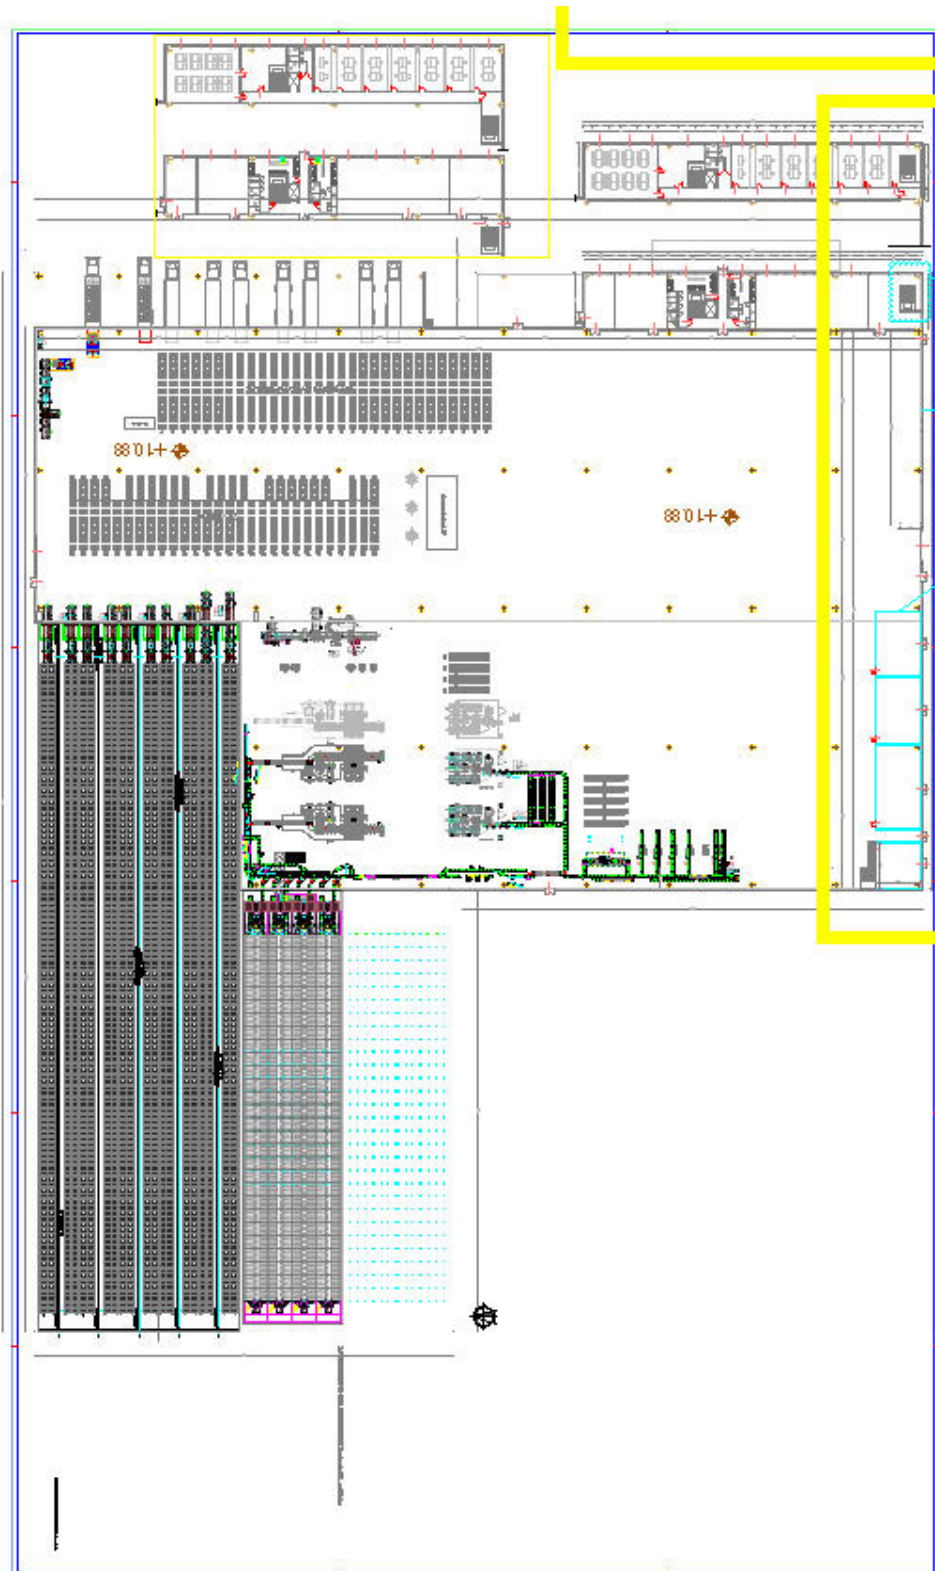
elaborati progettuali (layout uffici, piano secondo)
